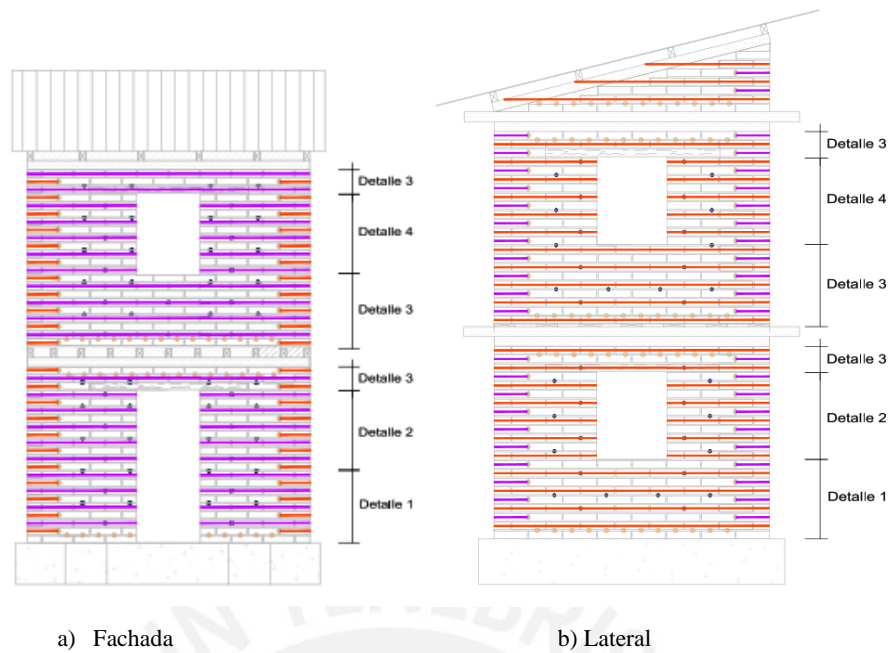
Refuerzo horizontal, fachada y lateral
